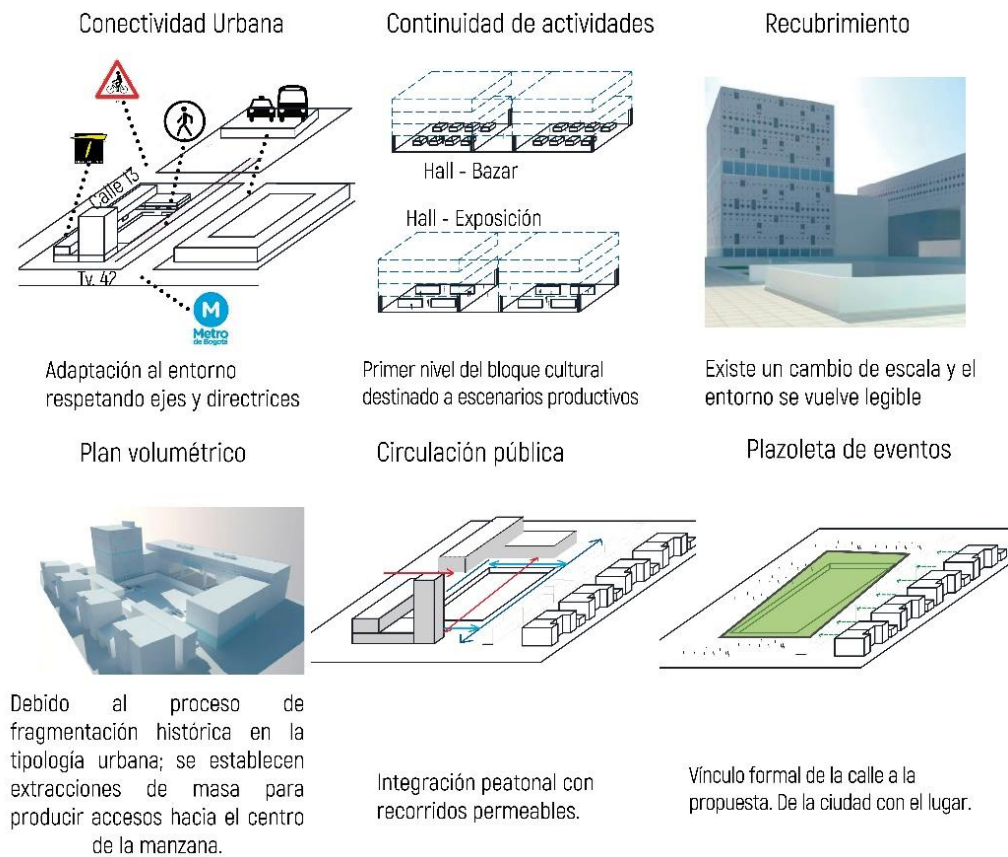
Estrategias arquitectónicas para la construcción de la propuesta. *Fuente:* Elaboración propia. 2018. CC BY.
